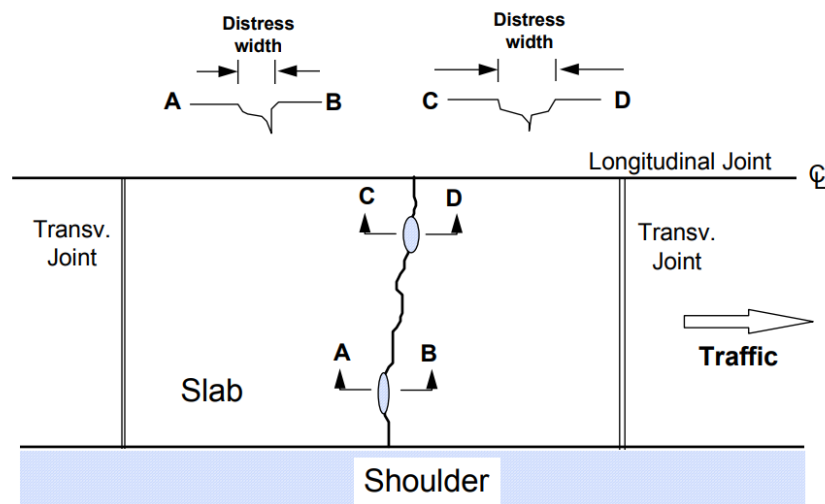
รูปแบบการเกิด Transverse Joint Spalling
